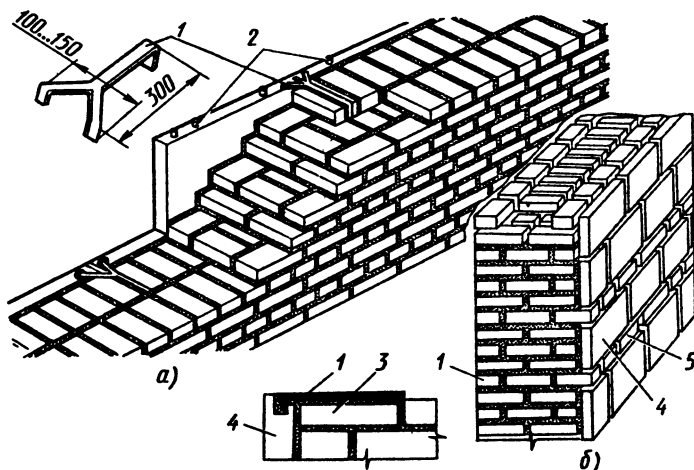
Кладка стен с одновременной облицовкой плитами: *а* — из природного камня, *б* — силикатными или керамическими; 1 — анкер, 2 — пирон, 3 — кирпич, 4 — прислонные облицовочные плиты, 5 — прикладной ряд плит
